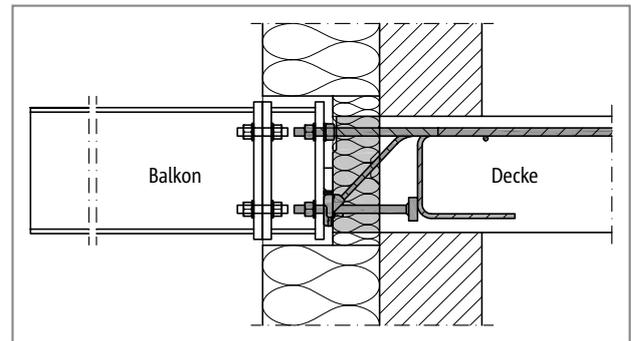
Schöck Isokorb® T Typ SK: Anschluss des Stahlträgers an einen Adapter, der die Dicke der Außendämmung ausgleicht
